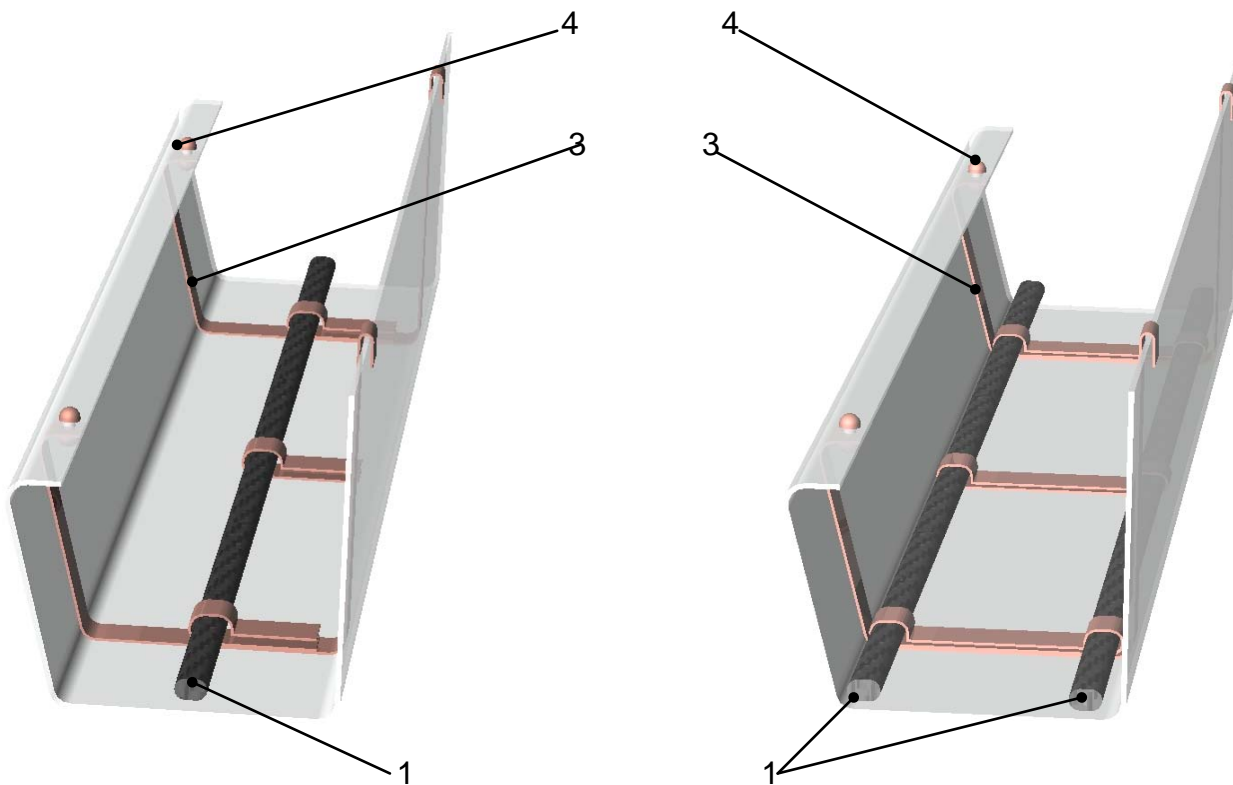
Крепление нагревательного кабеля в прямоугольных подвесных лотках.
